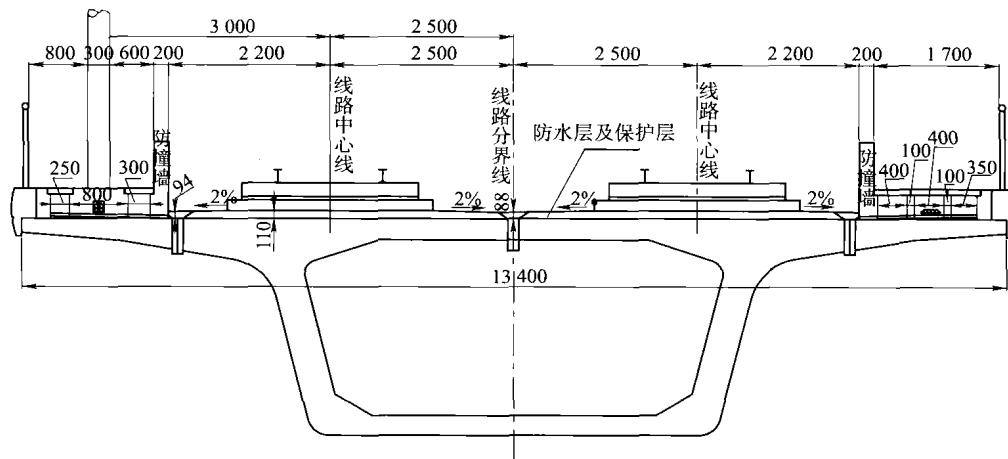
纯客运高速铁路箱形梁横断面示意(单位:mm)
